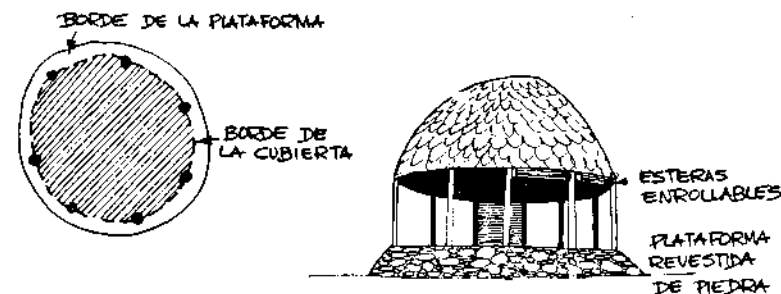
Vivienda de Samoa, plano esquemático y perspectiva.
